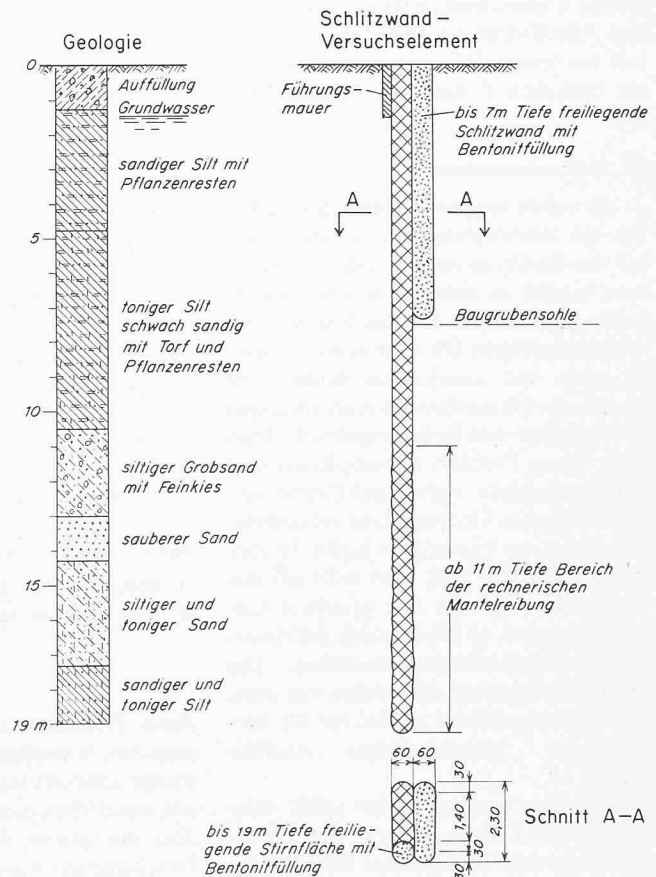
Einrichtung für den Belastungsversuch am 19 m tiefen Schlitzwandelement
